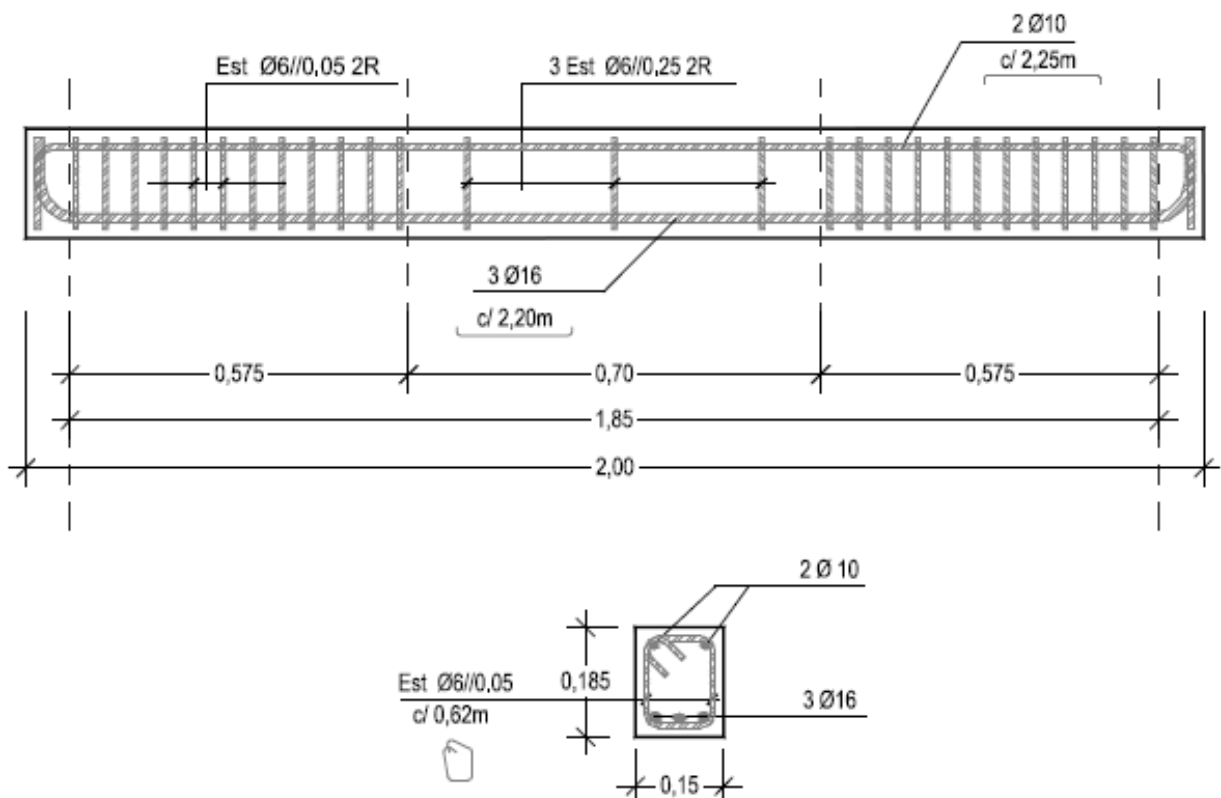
Pormenorização da armadura da viga de referência (Gião, 2012)
